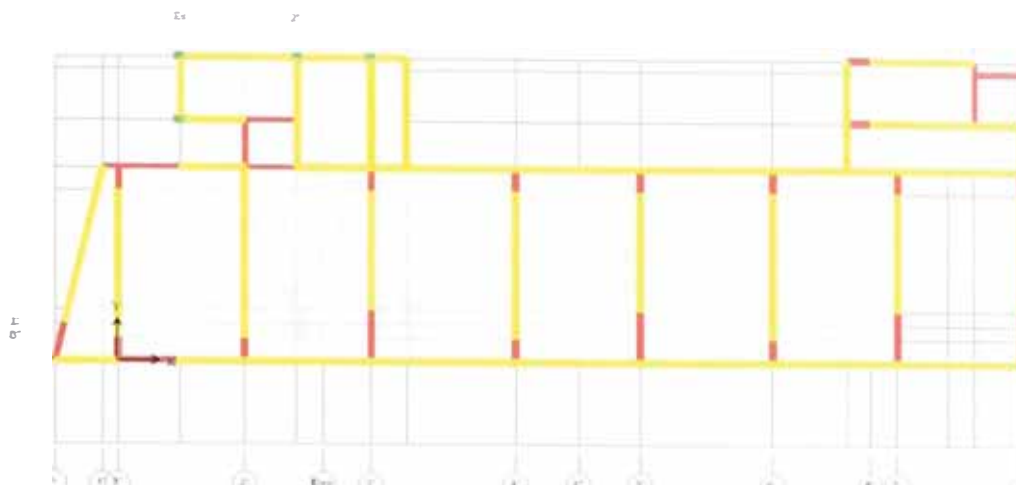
Distribución en planta de muros, vigas y columnas del Nivel Típico
